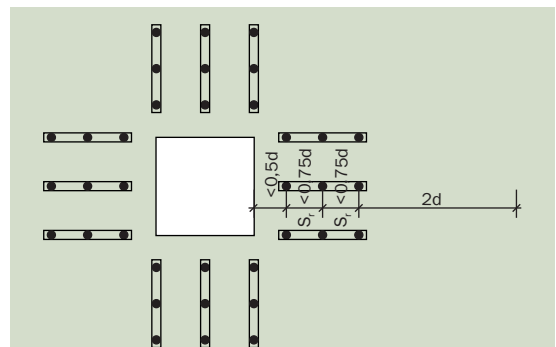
CONECTORES COMO ARMADURA DE PUNÇÃO - VISTA EM PLANTA
